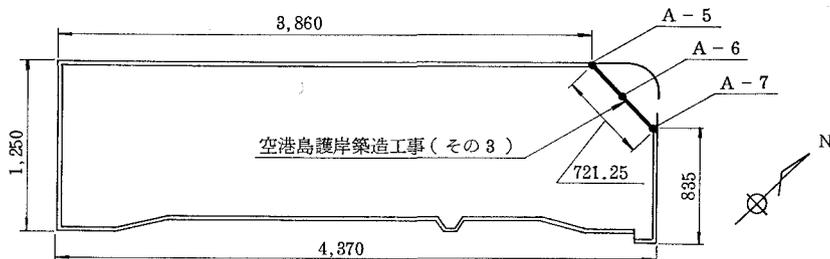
空港島全体平面図 ※A-5, A-6, A-7はボーリング位置を示す。
